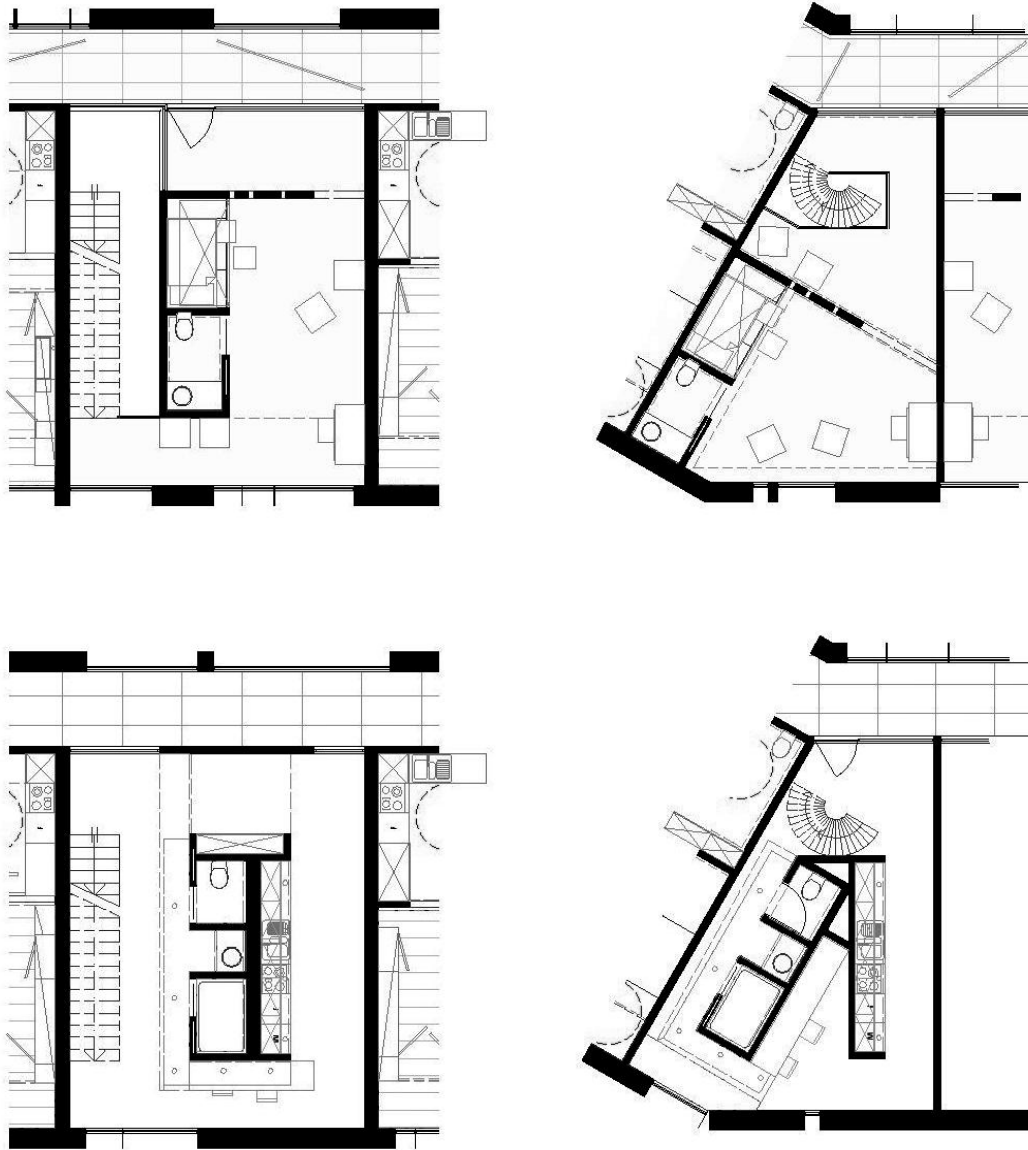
planta do piso 1 e do piso 2. Dúplex
